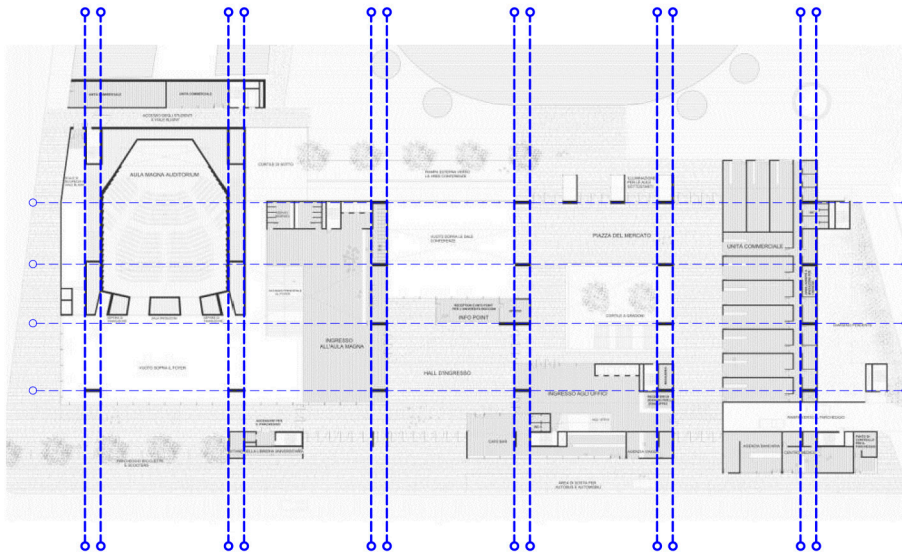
Planta baja de la Universidad Bocconi en Milán.
